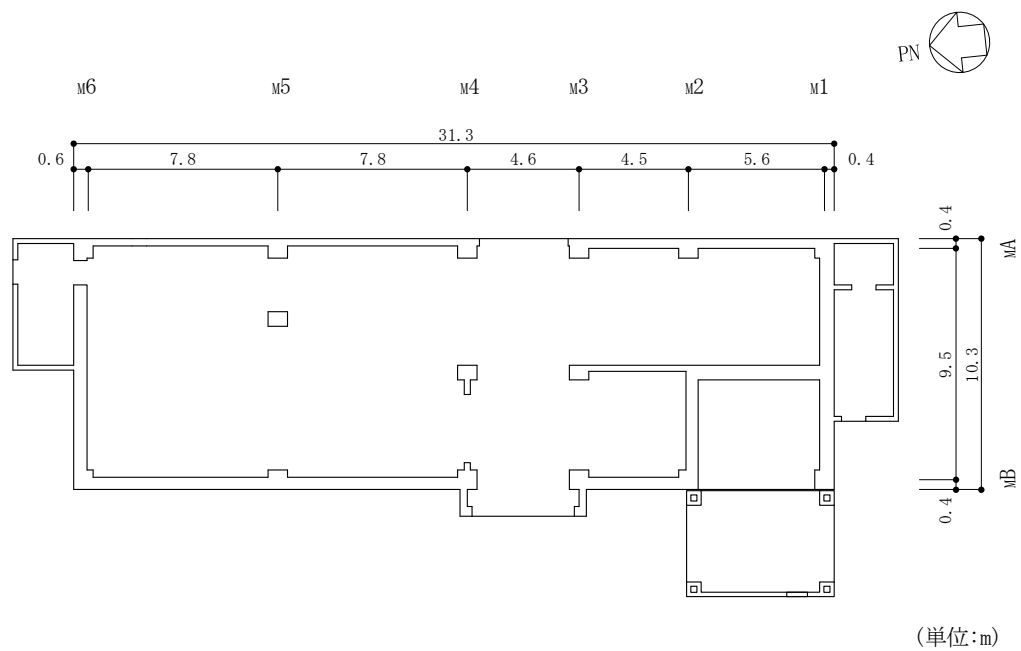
サイトバンカ建物 (増築部) の概略平面図 (EL 8.8m*)
